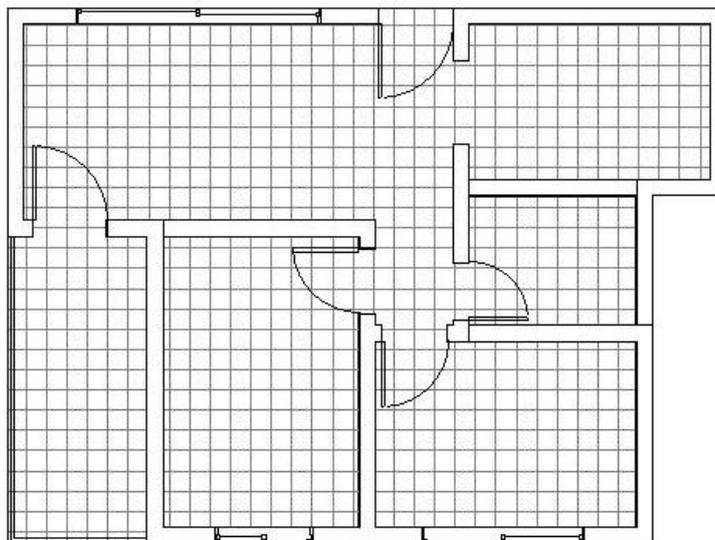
Planta Baixa - Revestimento Cerâmico no Piso
